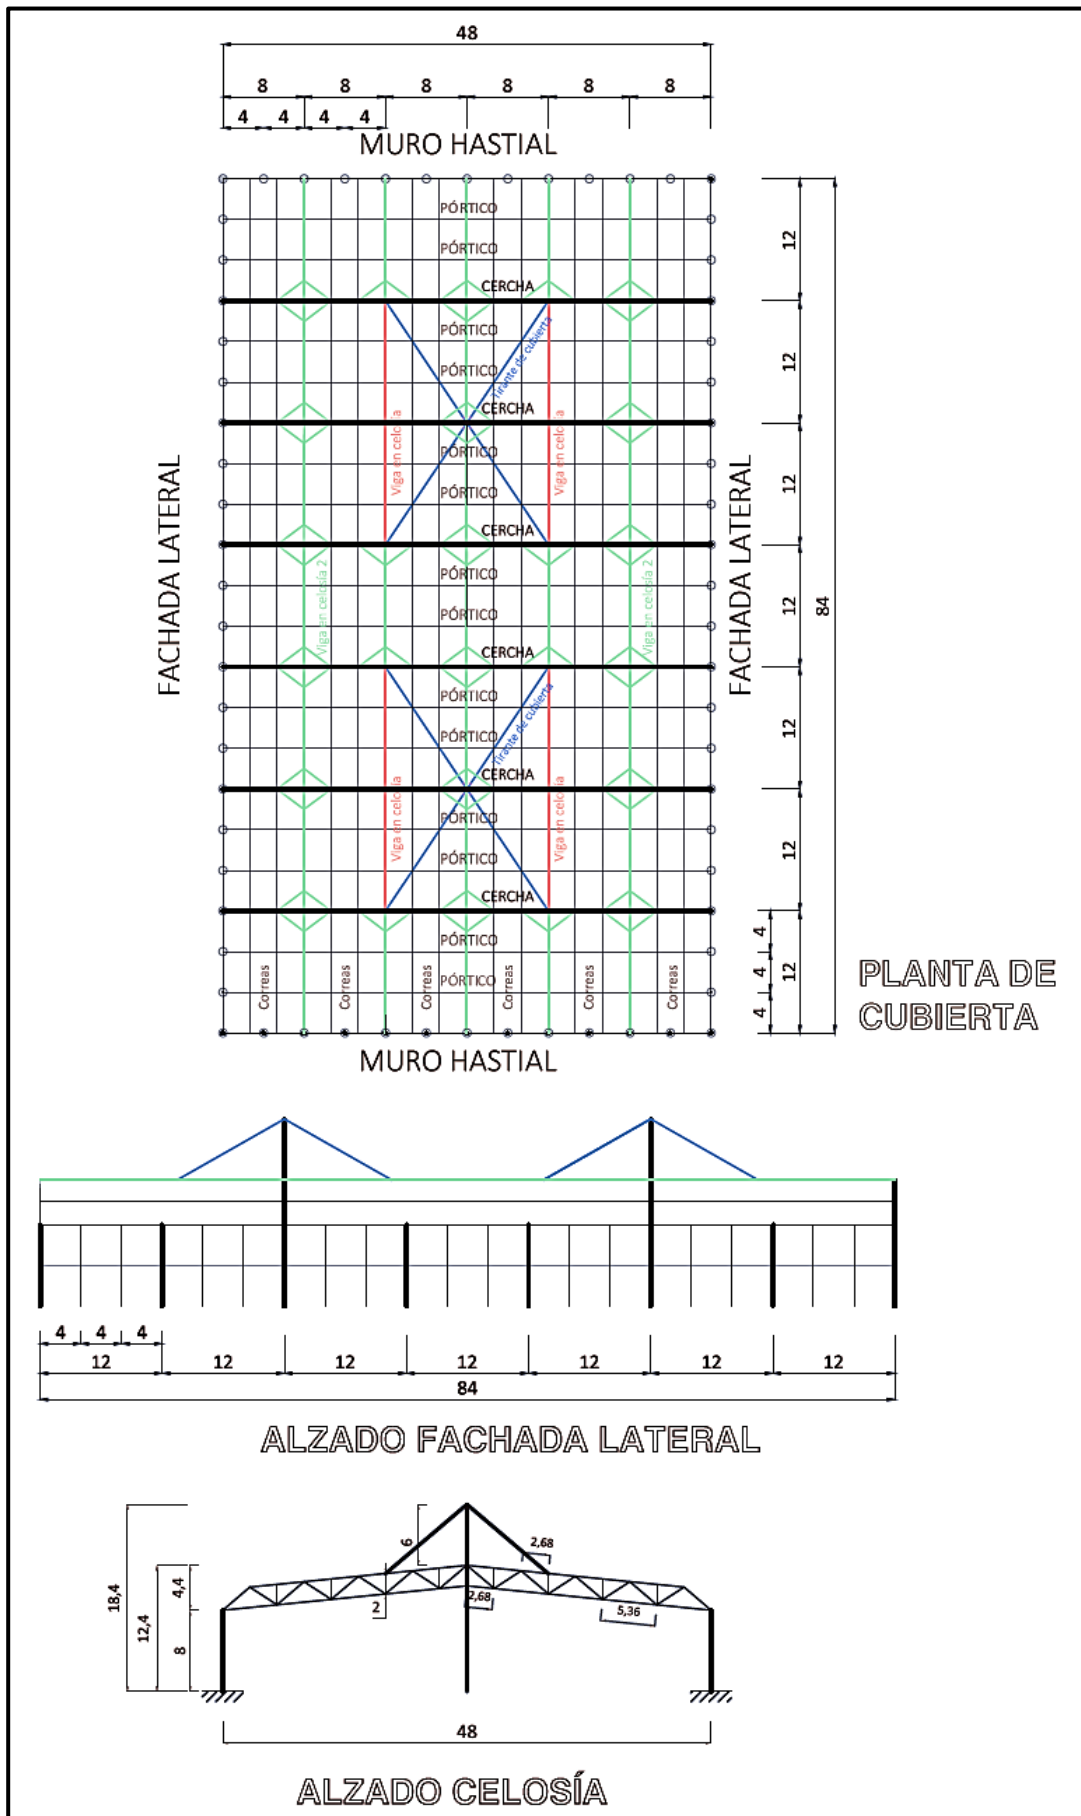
Planta de cubierta. Alzados de muro hastial y fachada lateral (Cotas en m).
